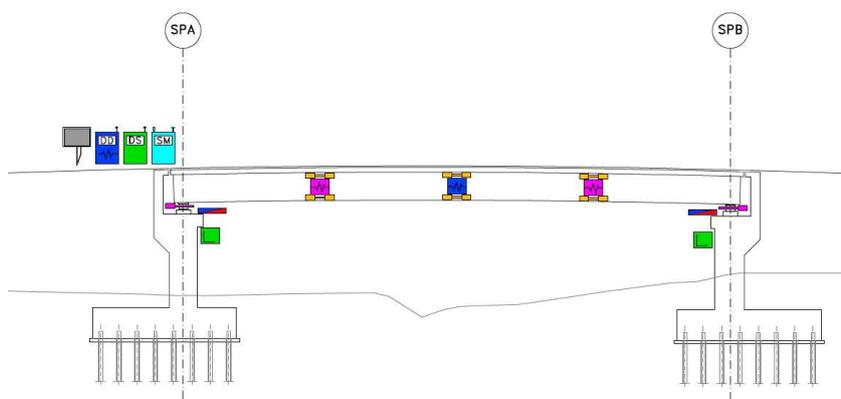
Schema profilo impalcato posizionamento strumentazione cavalcavia
